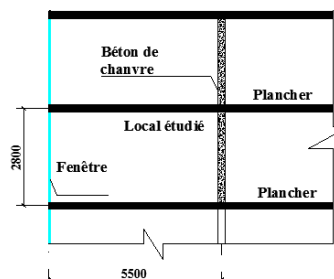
Coupe longitudinale du bâtiment étudié (unité: mm)
